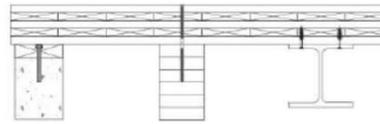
Appuis usuels de plancher sur support bois, métallique ou béton
